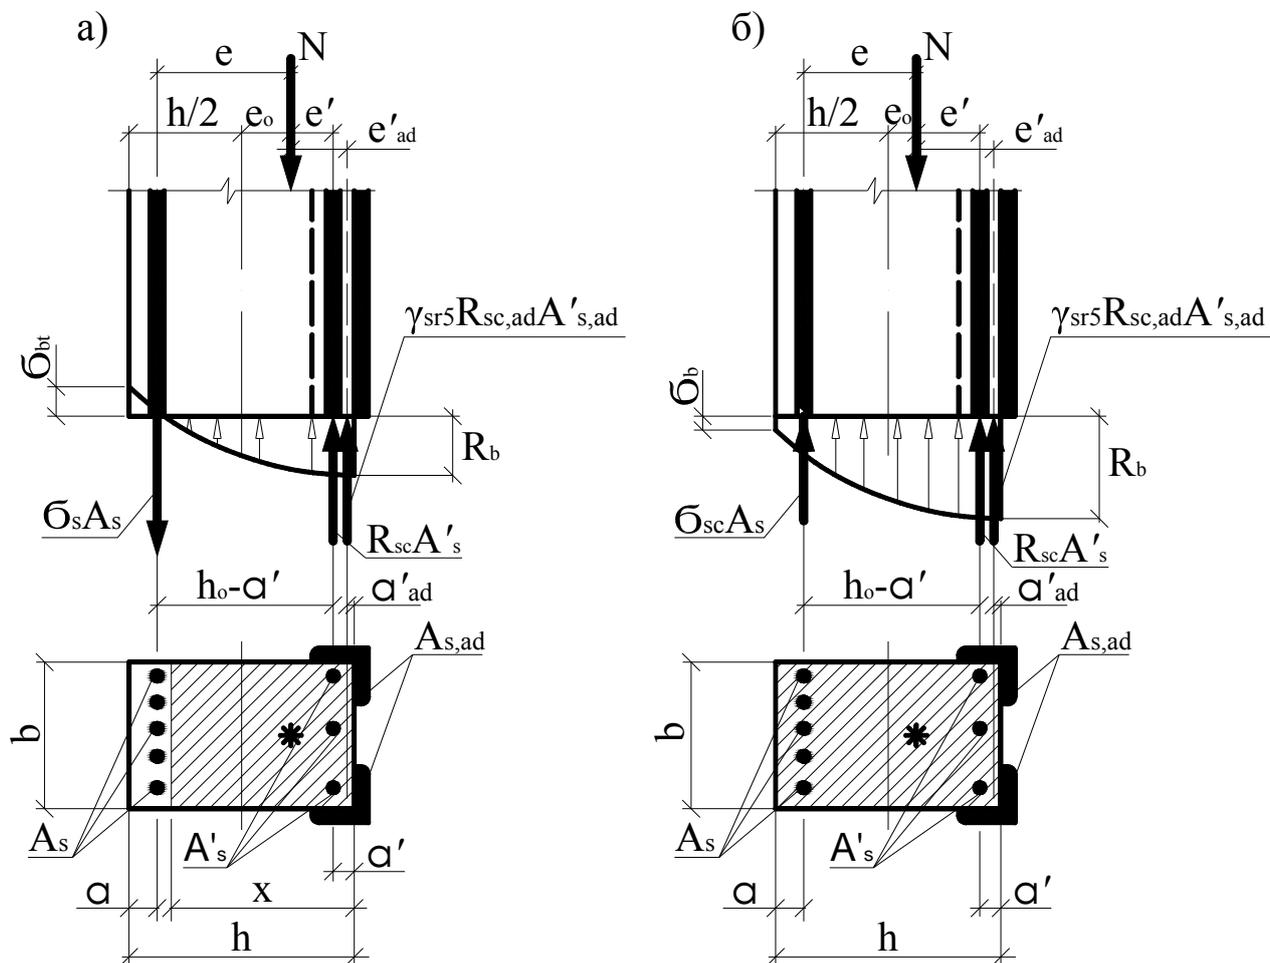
Расчетная схема для колонн, усиленных преднапряженными распорками при малых эксцентриситетах ($\xi > \xi_R$):
